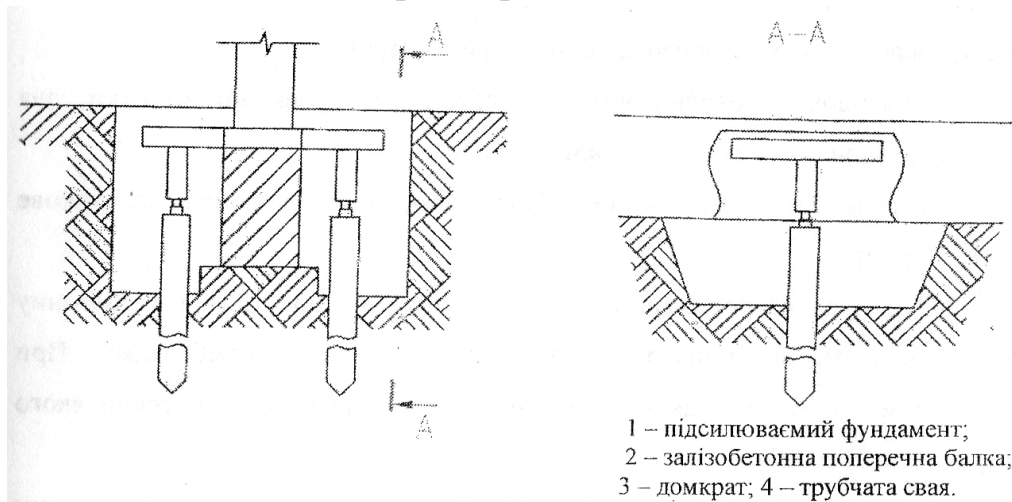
Схема підсилення фундаментів палями вдавлювання
